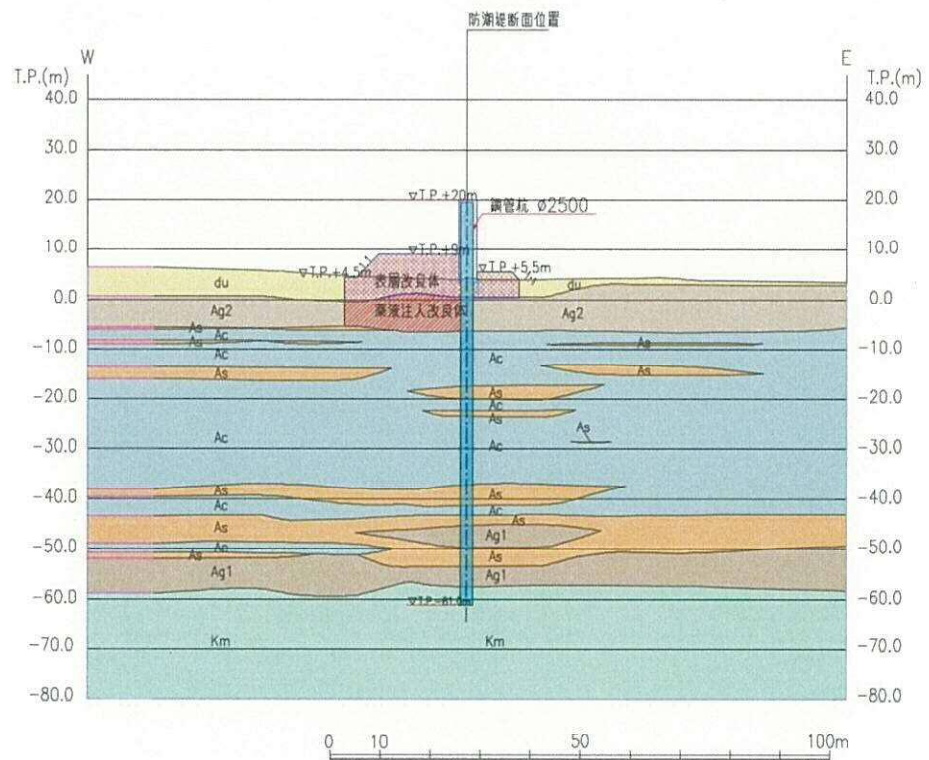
(2) 耐震評価対象断面（鋼管杭鉄筋コンクリート防潮壁 断面③）
